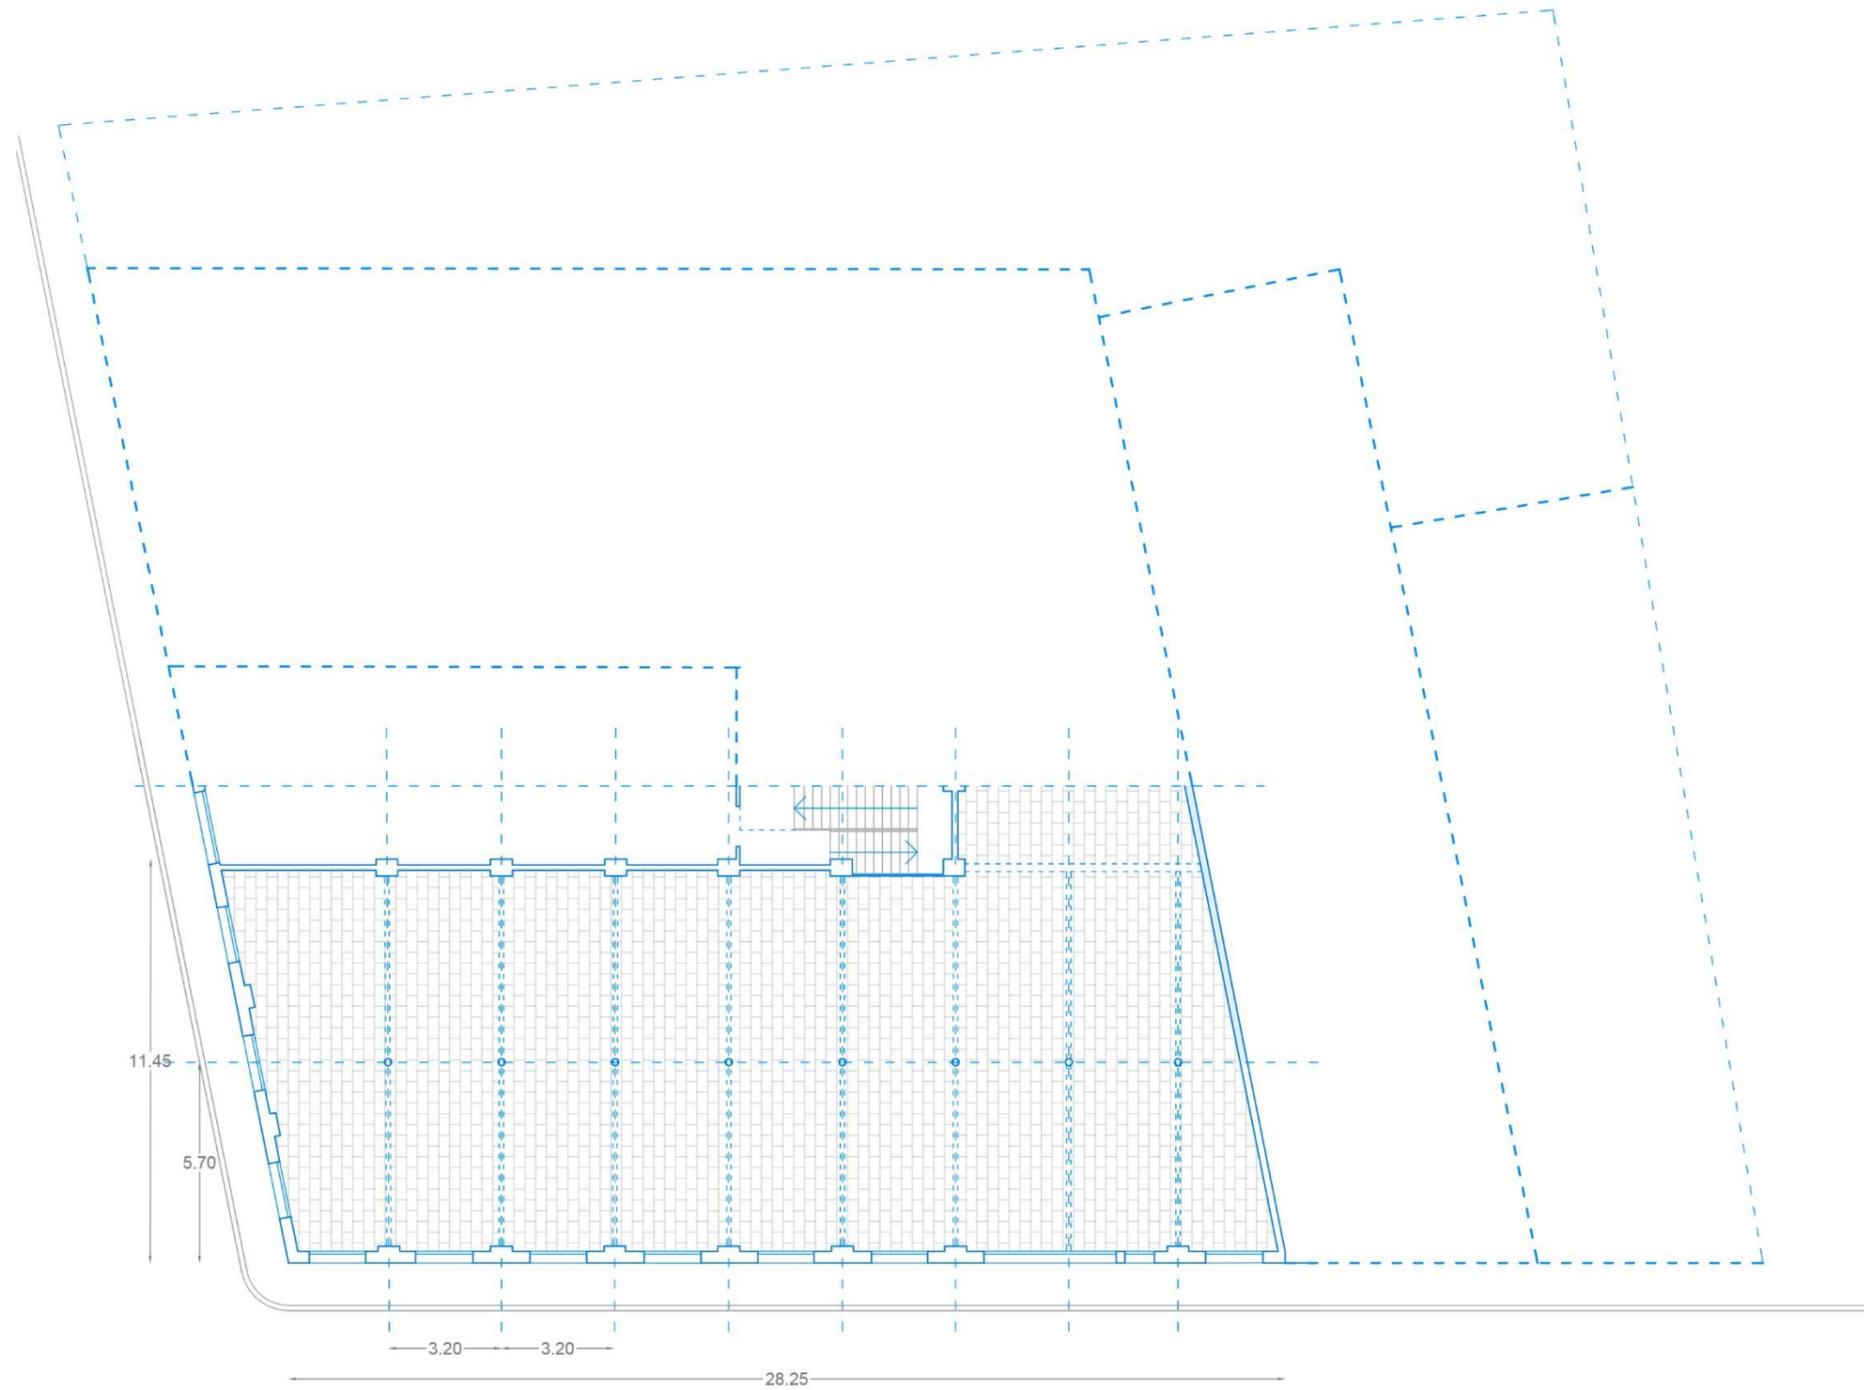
PLANO 1/200. Planta baja pre intervenció nave original fàbrica Tort Can Planell.
